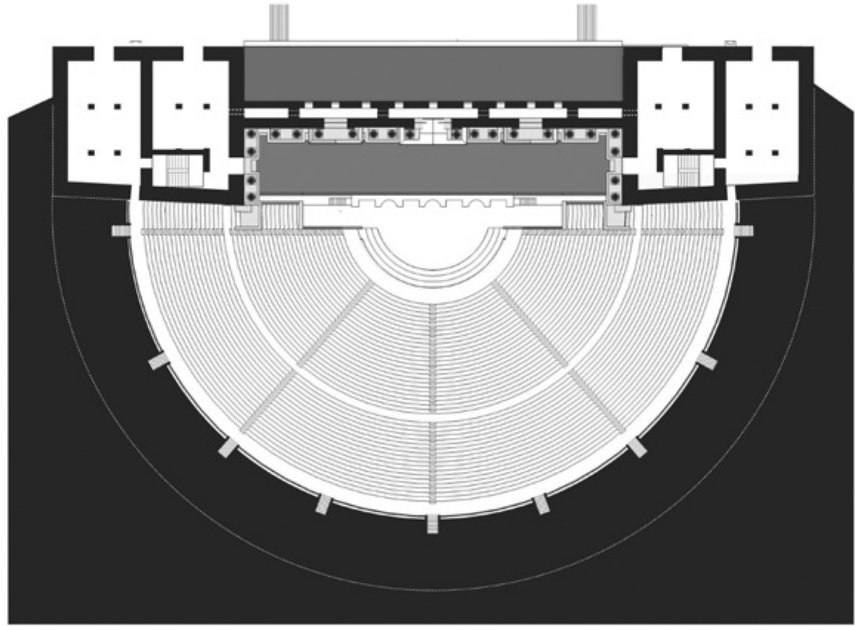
Reconstrucción del Teatro. Planta por la *media cavea*.
